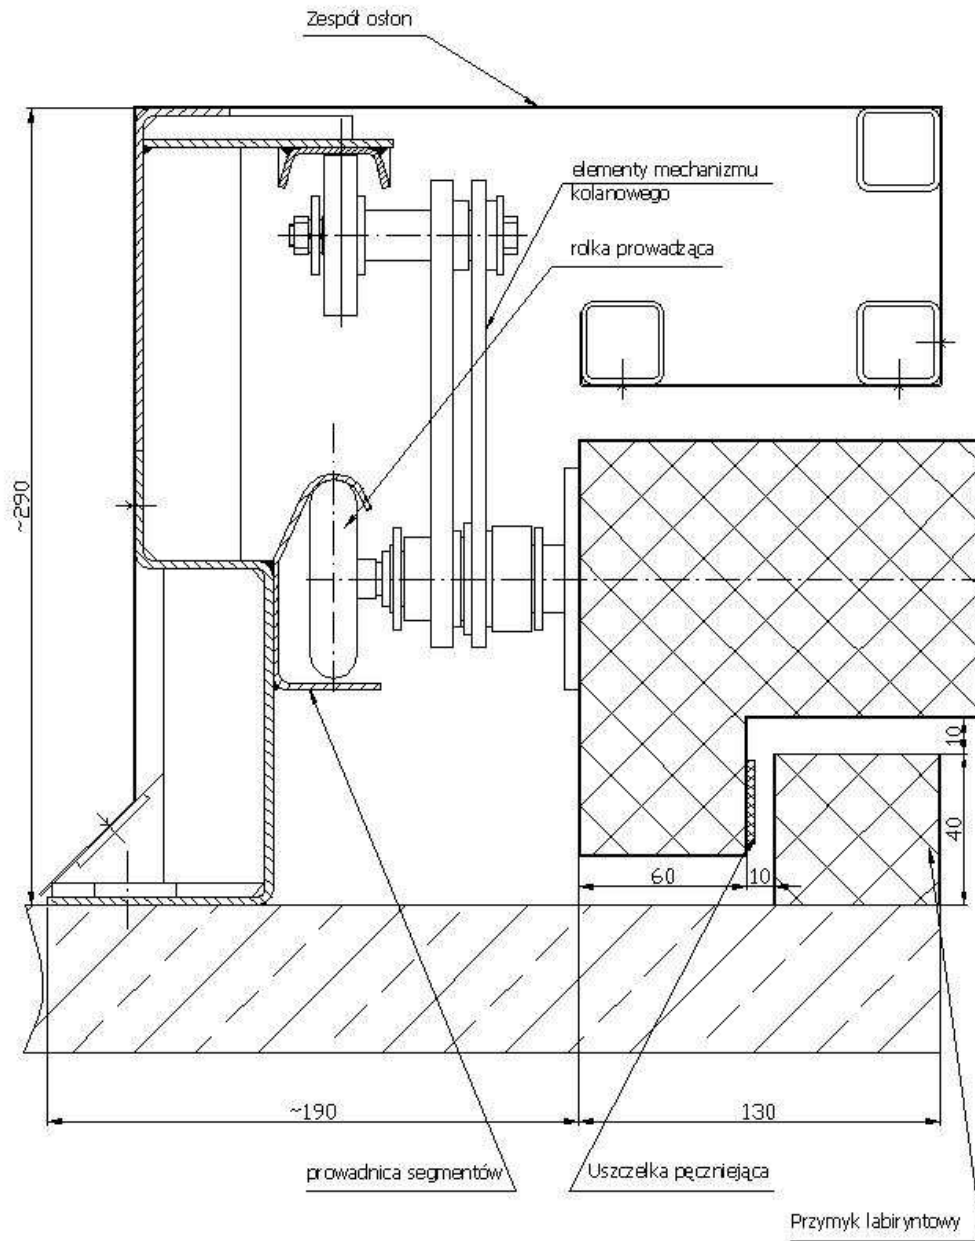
Widok ogólny bramy segmentowej typu MARC-S
